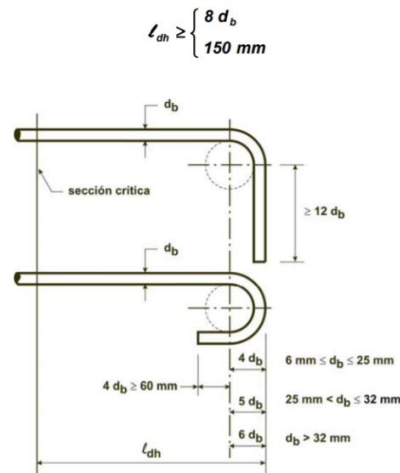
Detalle de los ganchos en las barras y alambres para efectivizar el anclaje de la armadura
